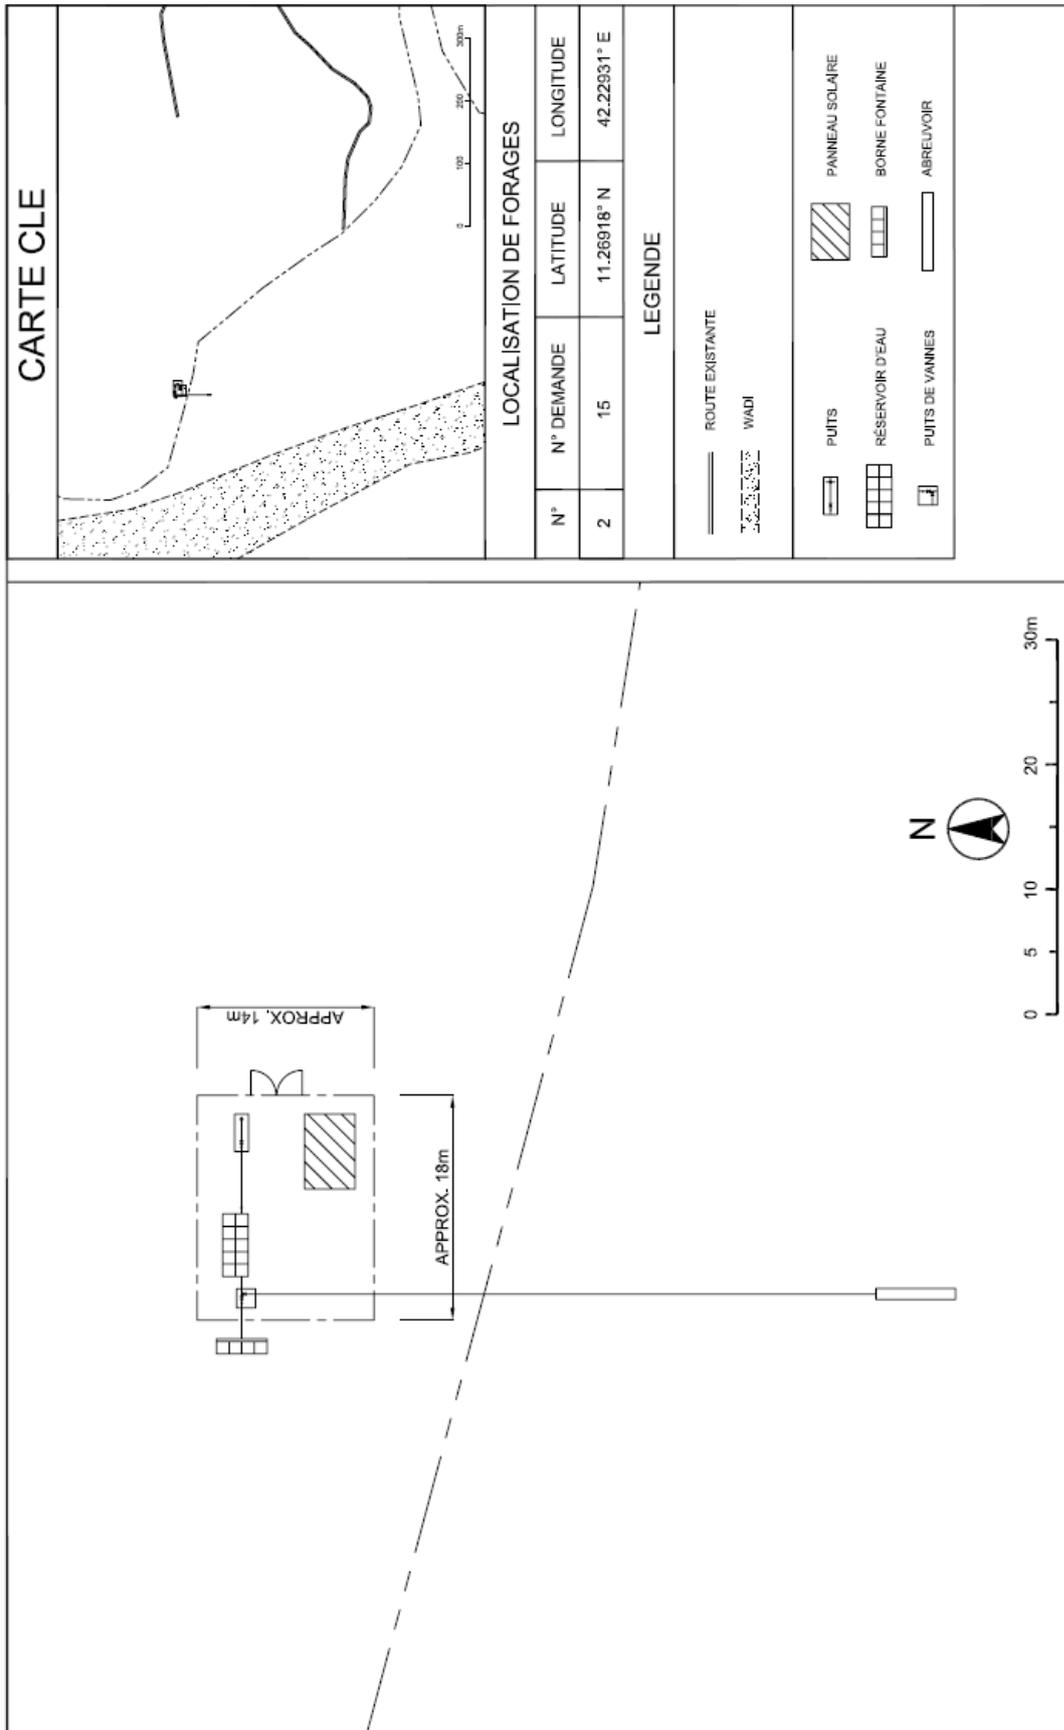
Plan d'implantation des installations (iv) [Sek Sabir]
